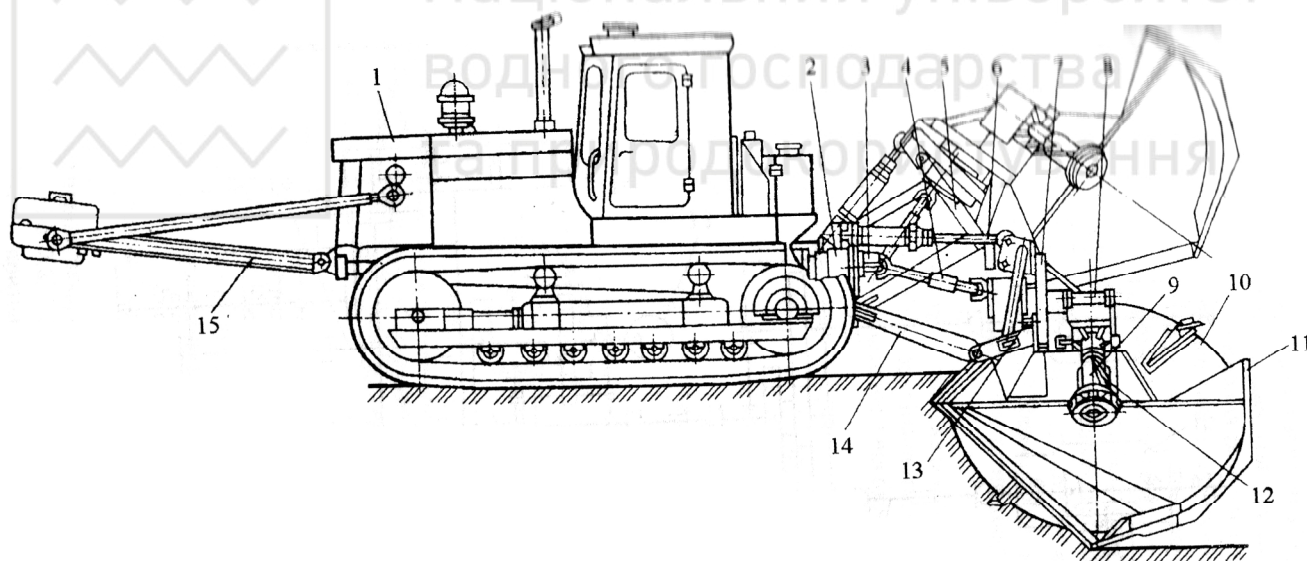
Каналокопач ЭТР-125А: 1 – трактор Т-130 БГ-3; 2 – ходозменшувач; 3 – огороження карданного вала; 4 – карданний вал; 5 – фіксуюча щока; 6 – гідроциліндр повороту робочого обладнання; 7 – рама; 8 – конічний редуктор; 9 – планетарний редуктор; 10 – фреза; 11 – зачисний відвал; 12 – розпушувач; 13 – карданна муфта; 14 – нижня тяга начіпної системи трактора; 15 – противага
